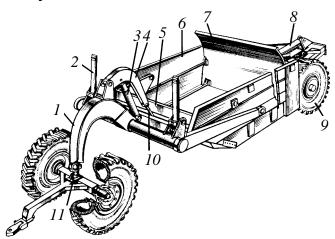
Скреперное оборудование скрепера: 1 – рама; 2, 3, 8 – гидроцилиндры; 4 – рычаг; 5 – заслонка; 6 – ковш; 7 – задняя стенка; 9 – колесо; 10 – тяга; 11 – передняя ось
